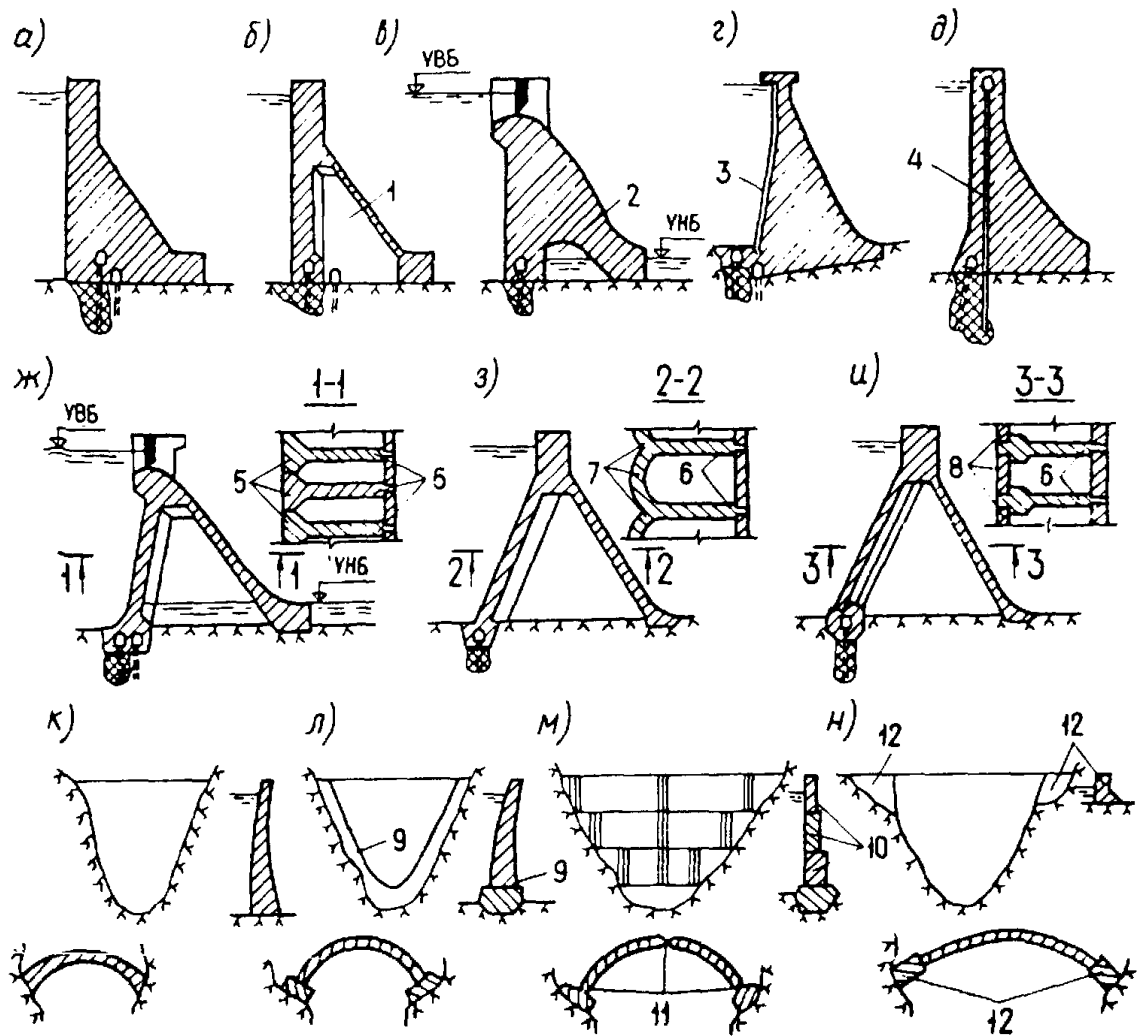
Основные виды бетонных плотин на скальных основаниях
